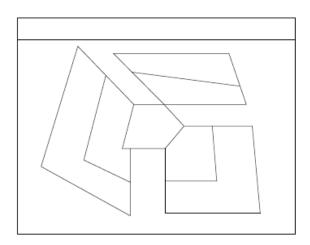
Plano del lombricultivo. Fuente: Autor
